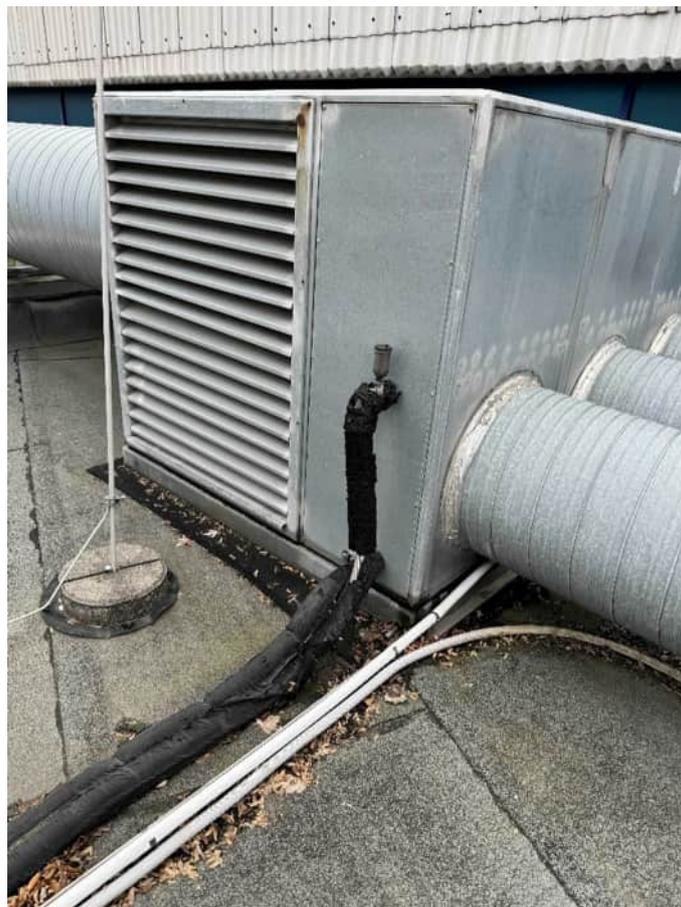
Dachbereich – Außenluftansaugung
